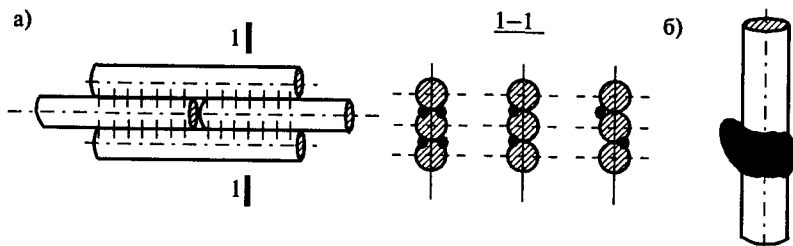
Стыки арматуры: а) с круглыми накладками; б) стык на ванной сварке
